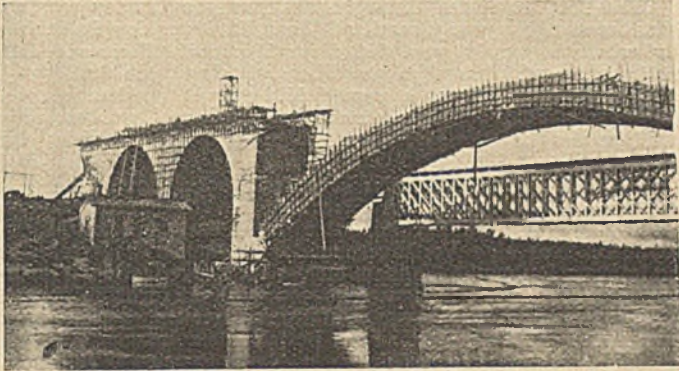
Ansicht der Brücke nach dem Gerüstunfall.
